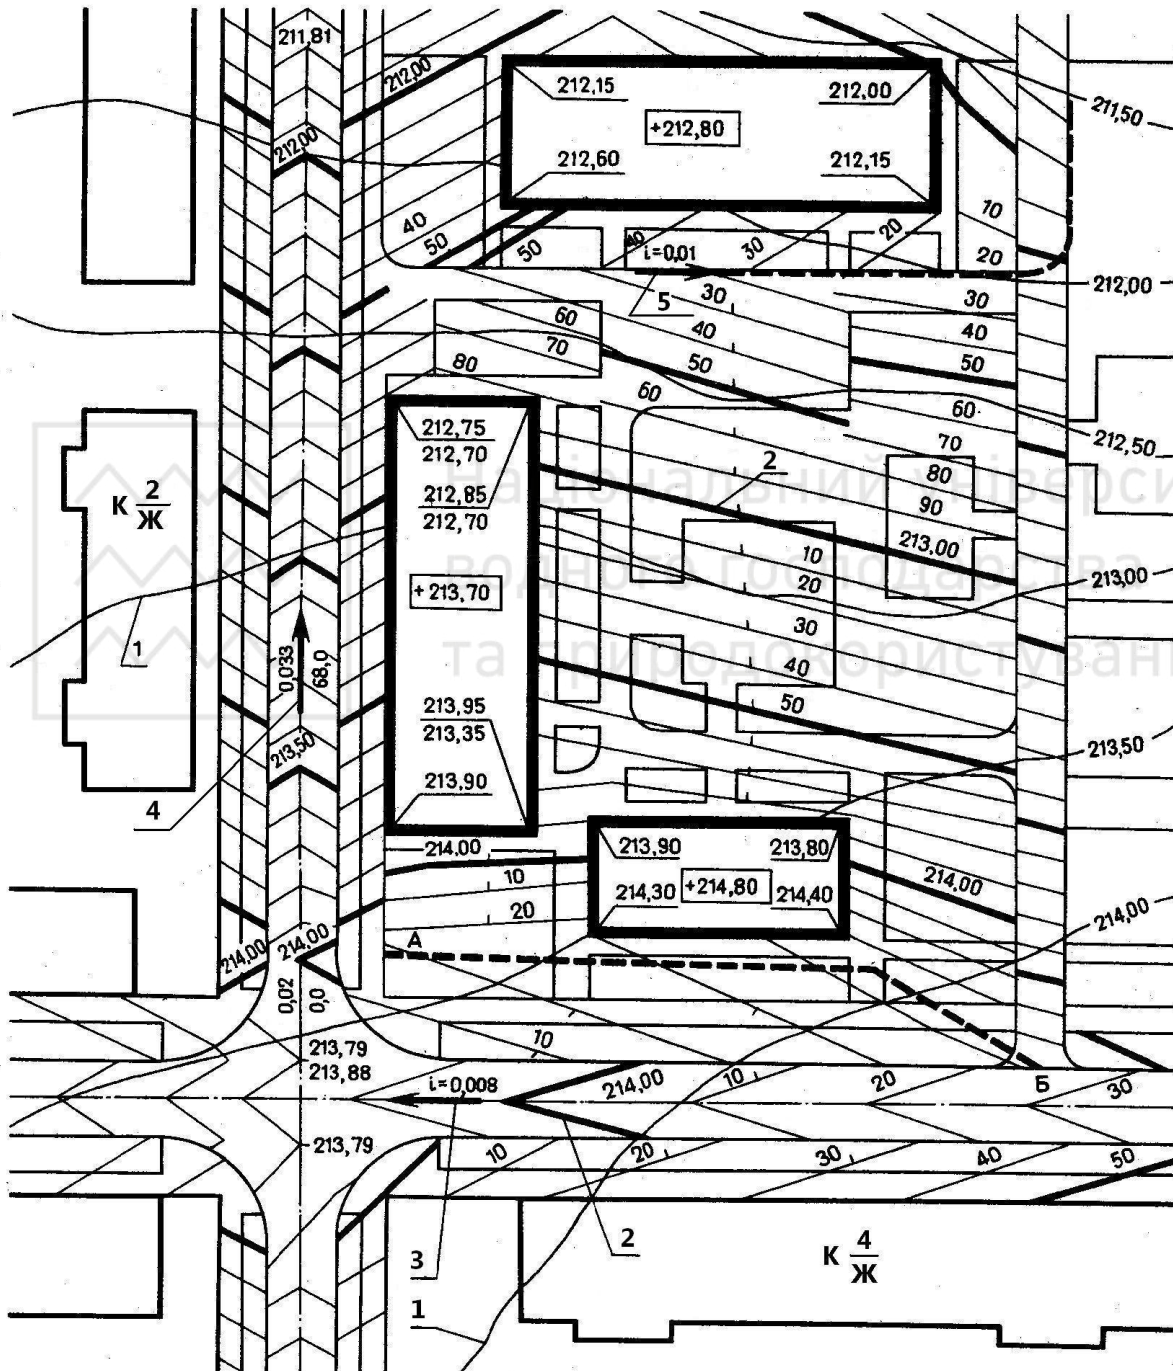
Креслення вертикального планування житлового кварталу, генплан якого наведений на рис. 6.37
